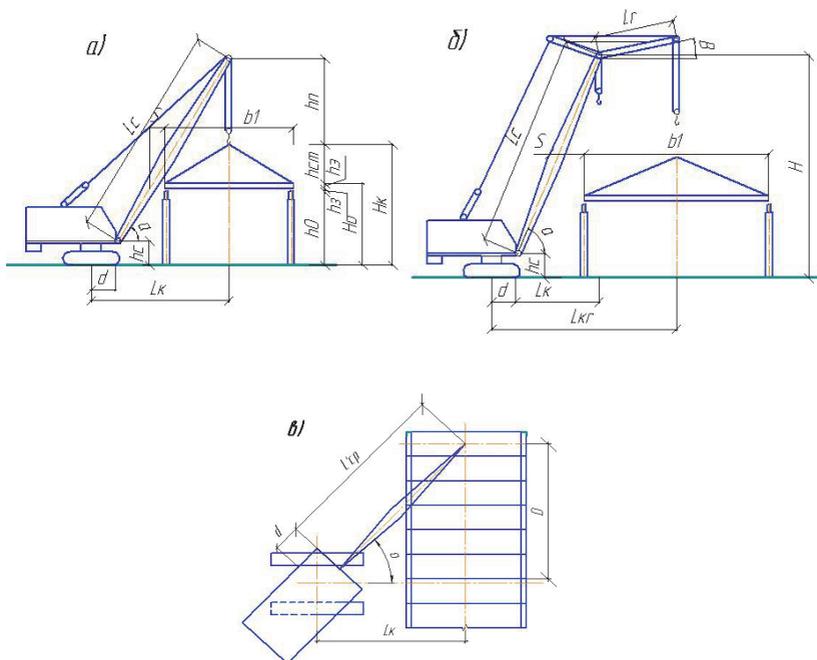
Схемы для определения требуемых технических параметров стрелового самоходного крана: а – без гуська; б – с гуськом; в – без гуська с поворотом в плане
